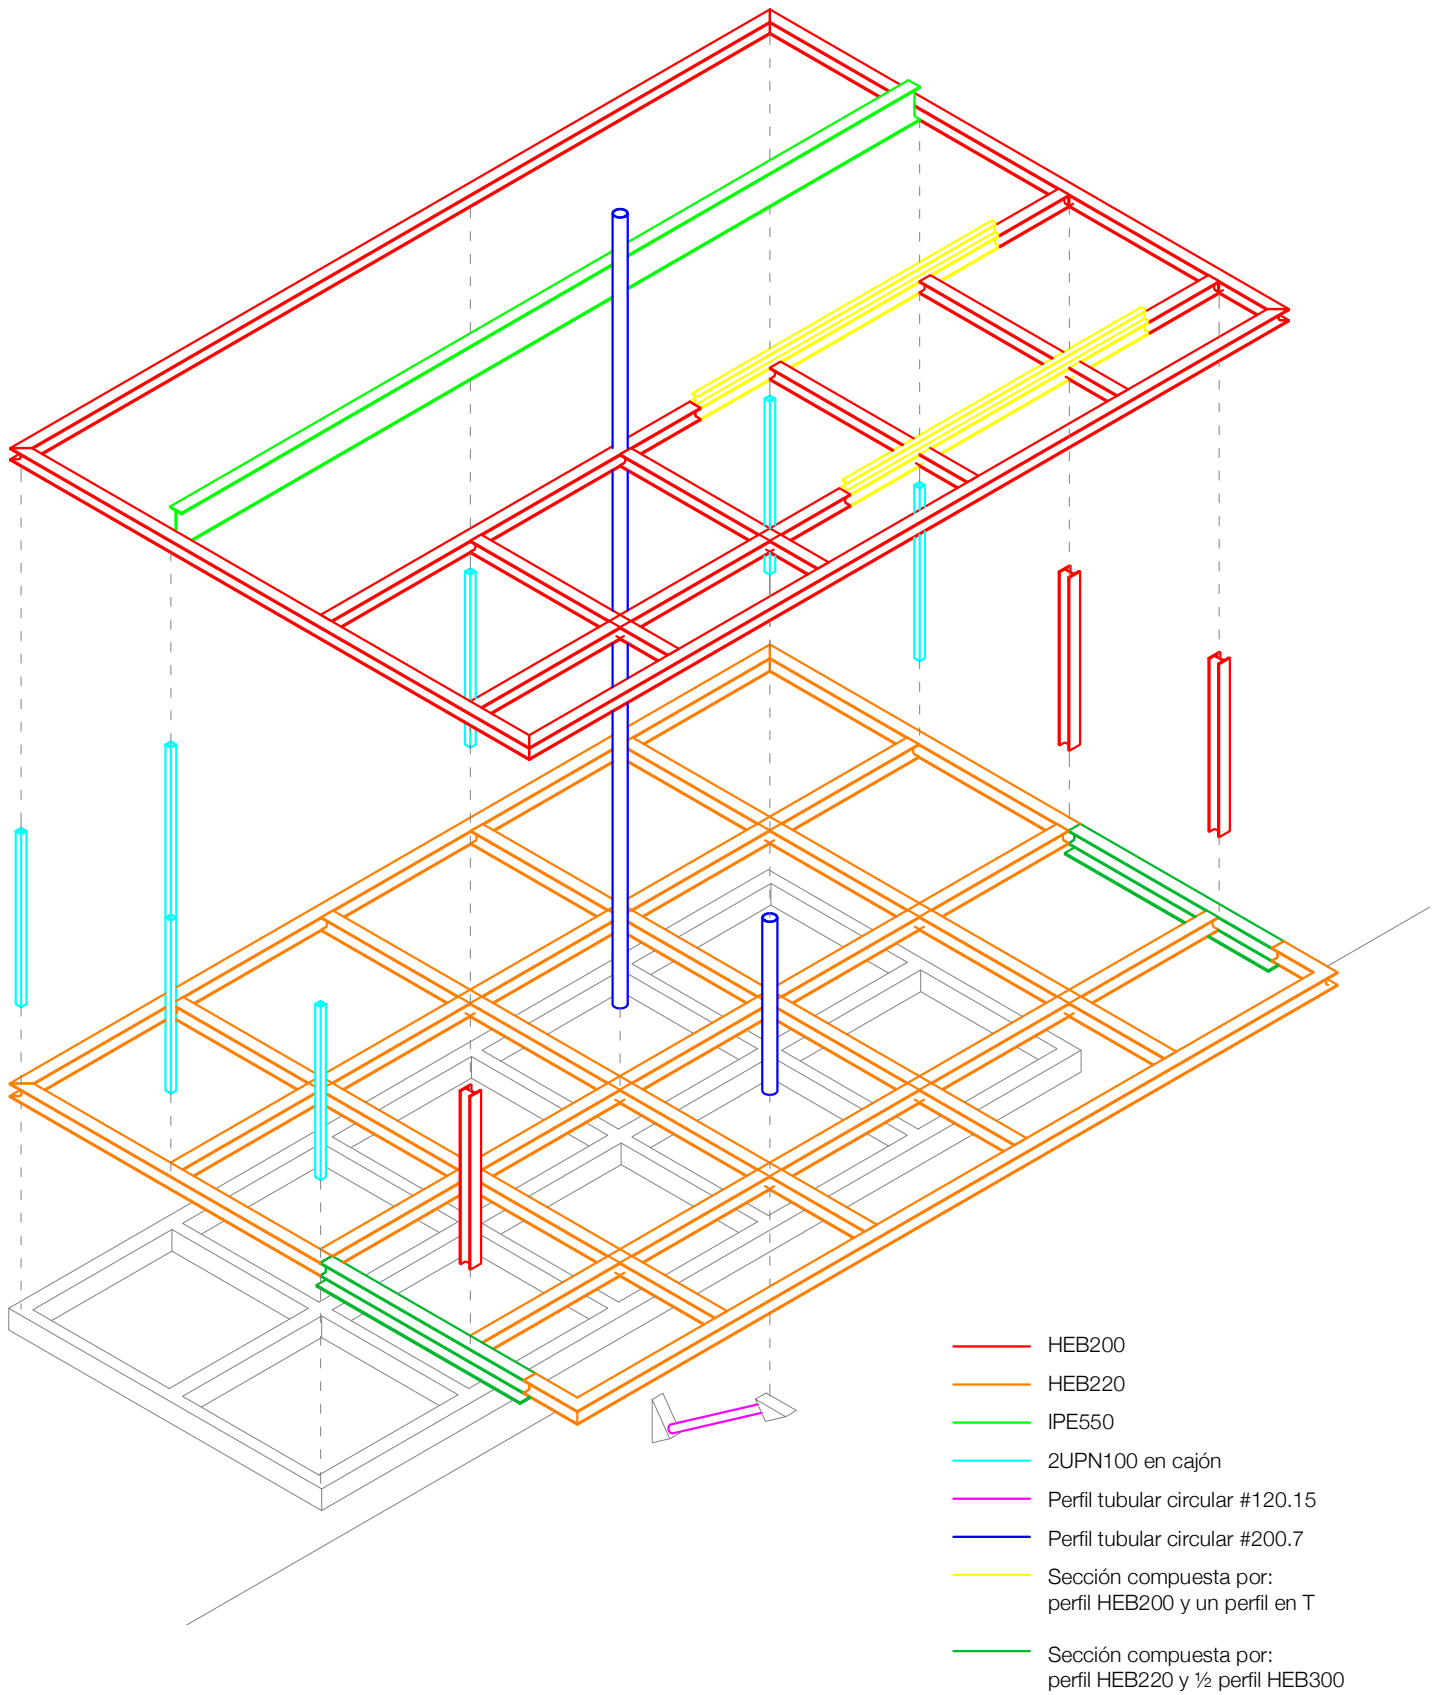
Axonometría dimensionado final de la estructura con codal de Autocad
